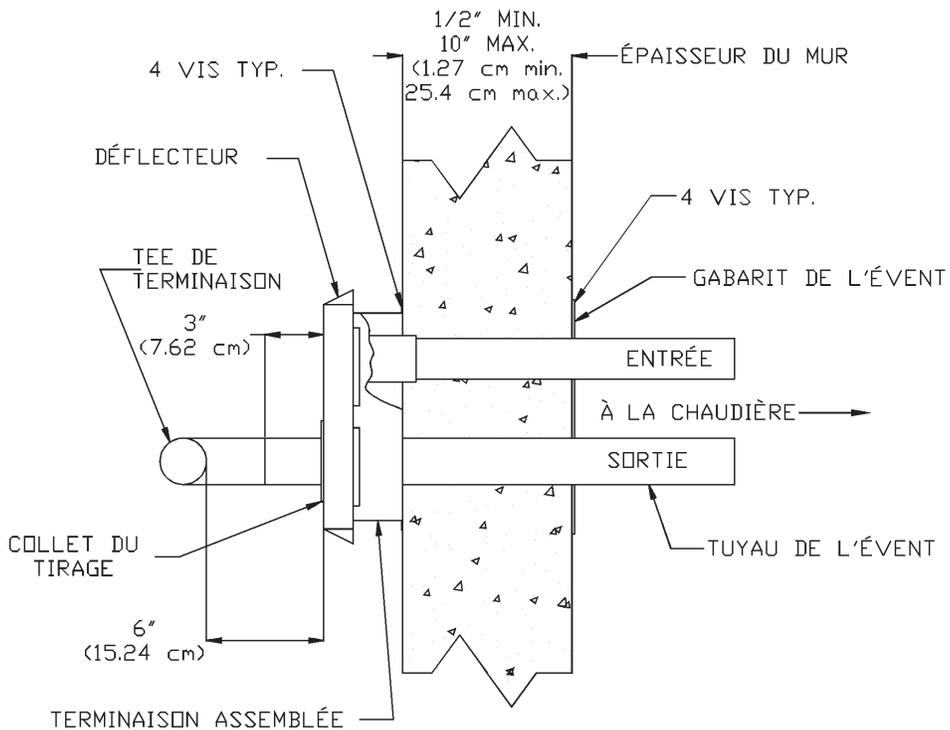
Mur Et Trousse De Termination Vu Du Haut
